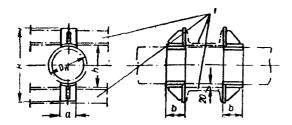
Опоры неподвижные, тип II для  $D_{\rm H} = 89 \div 219$  мм I- несущая конструкция
